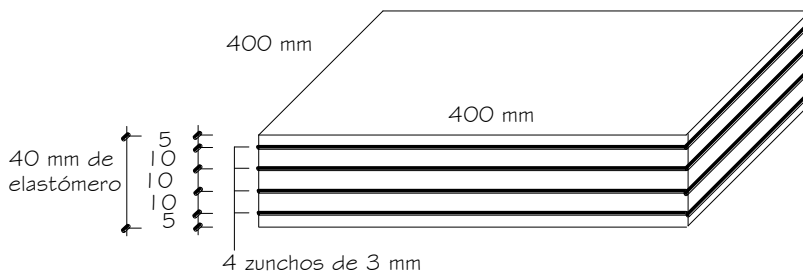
Distribución del elastómero y las planchas de acero en el dispositivo
